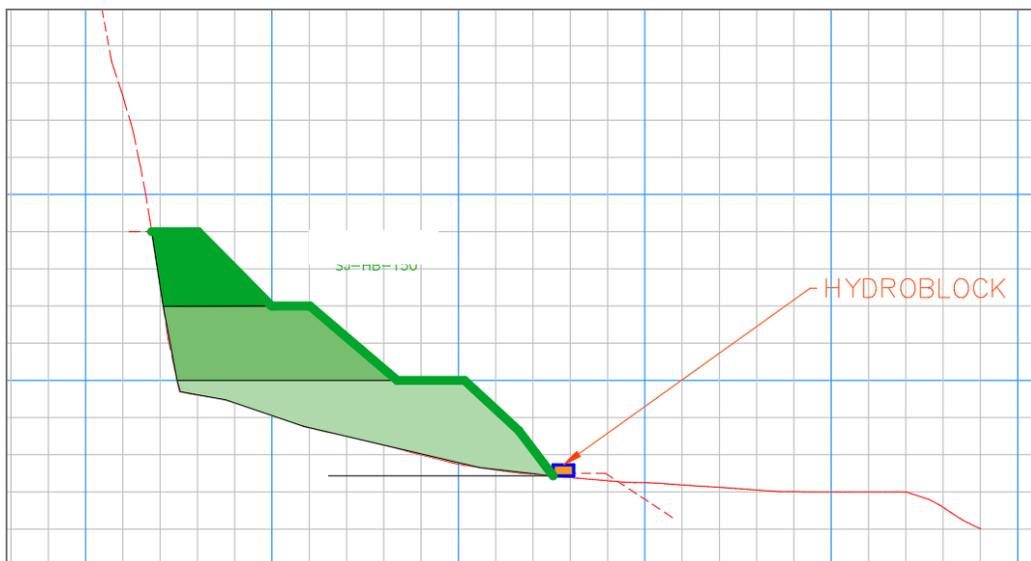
Detalle en perfil de ubicación de terrazas con hydroblock
